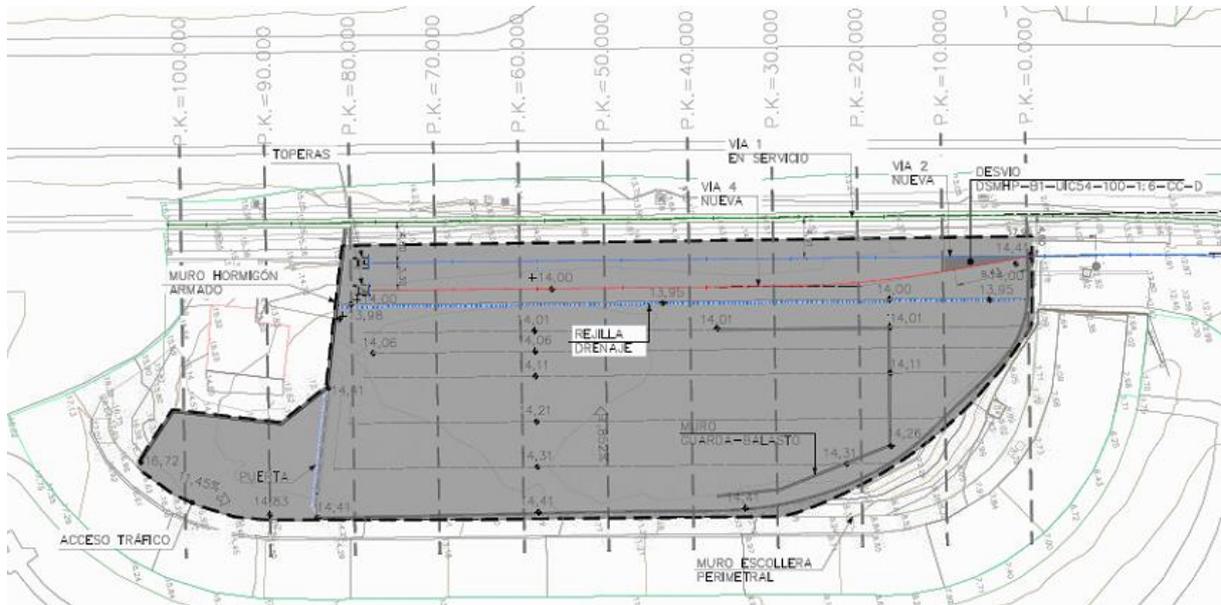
Losa de área de mantenimiento. Planta .P.P.K.K. de referencia de secciones..
